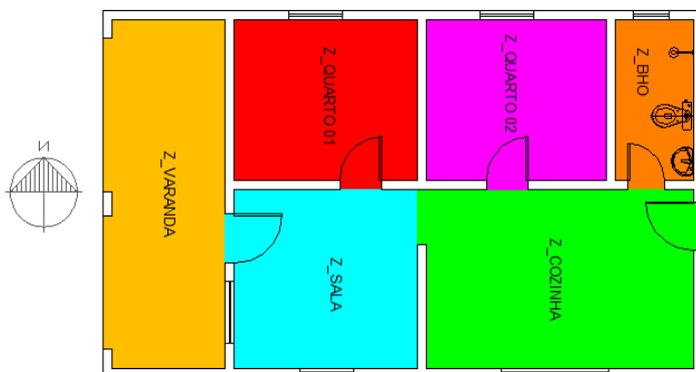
Planta baixa em zonas térmicas da tipologia palafita rural oeste
